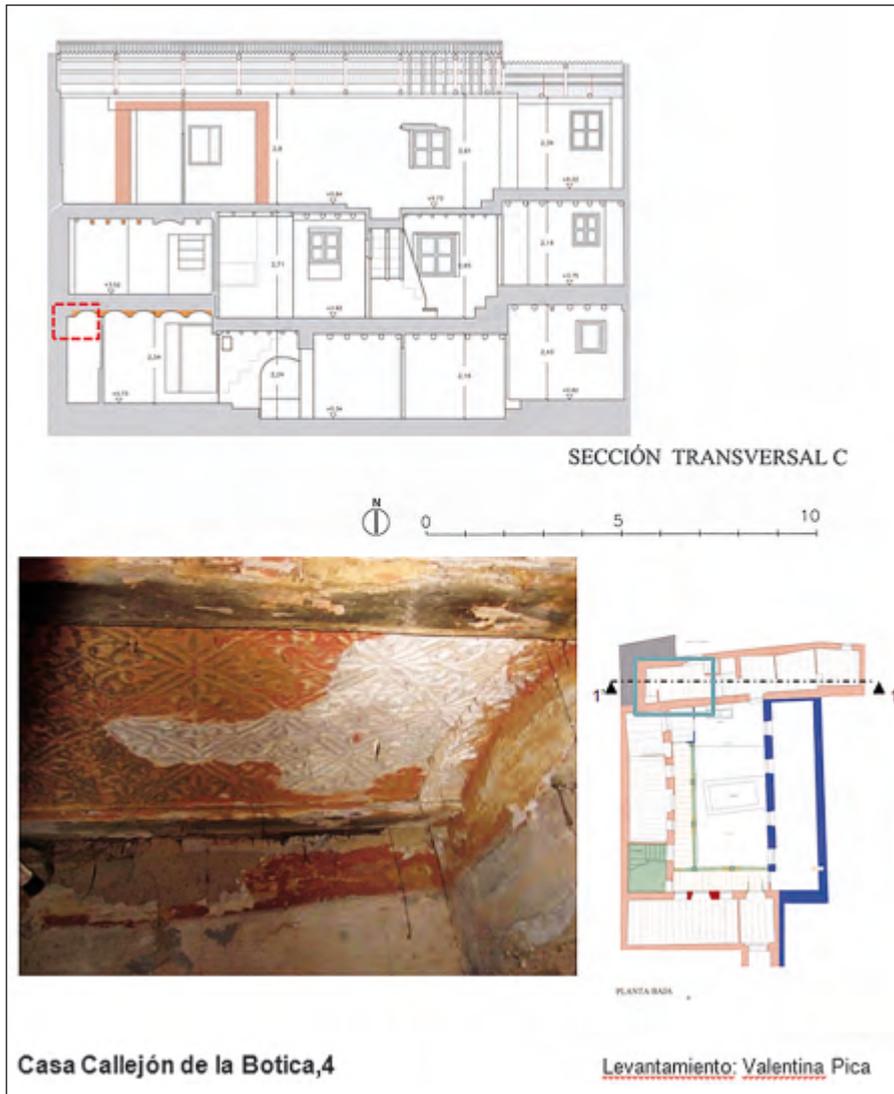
C8, Callejón de la Botica, 4. Bovedillas moriscas conservadas en el salón noroeste en planta baja.
